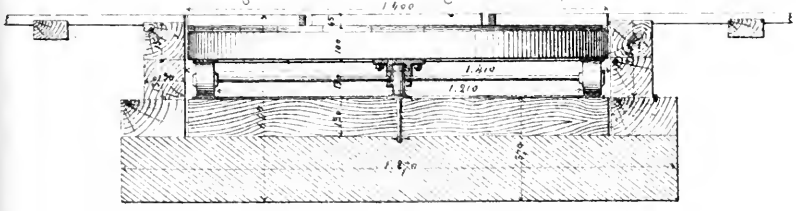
Elevⁿ, coupe de la crapaudine, à 0,20 p m
